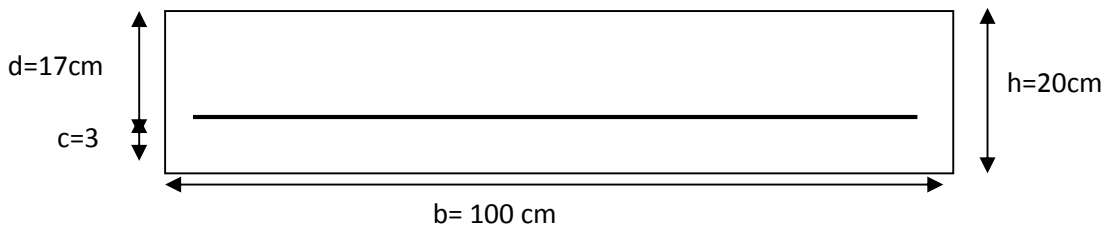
Schéma statique du ferrailage de mur plaque
